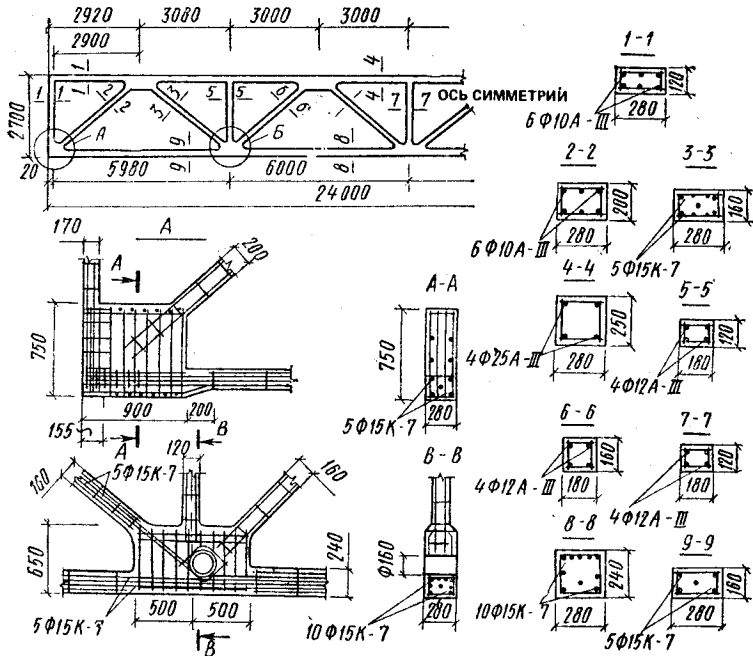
Армирование фермы с параллельными поясами пролетом $l=24$ м
